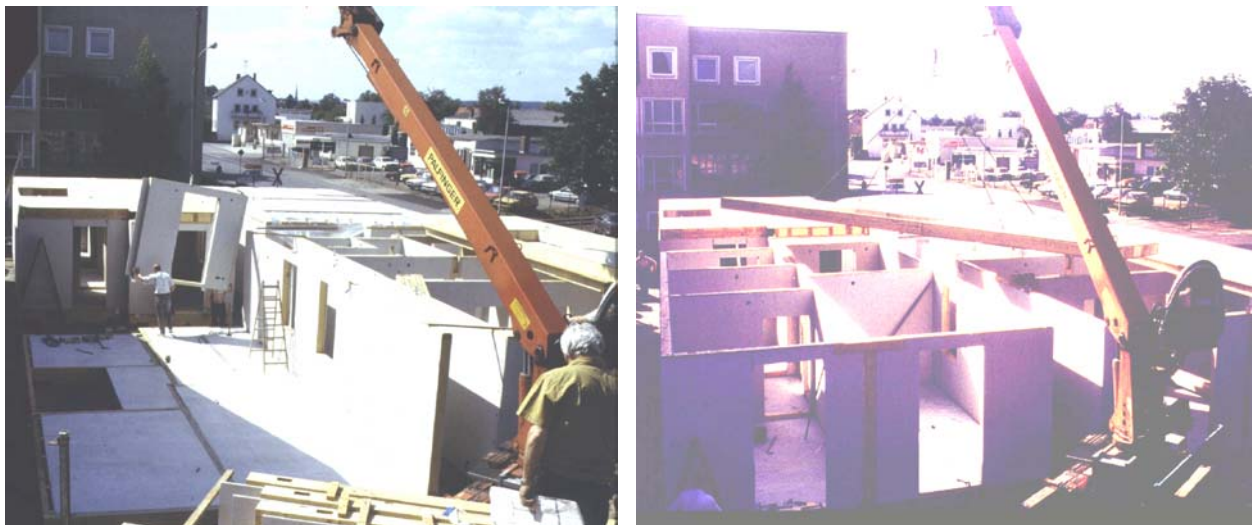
Wand- und Deckenmontage im Werk der Otto Baukmeier Fertigbau GmbH
